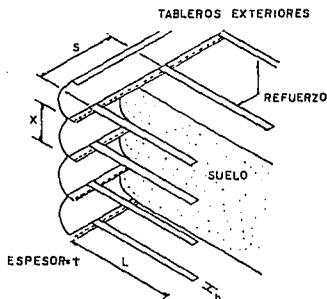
CONCEPCION DEL MURO DE TIERRA ARMADA DE VIDAL
